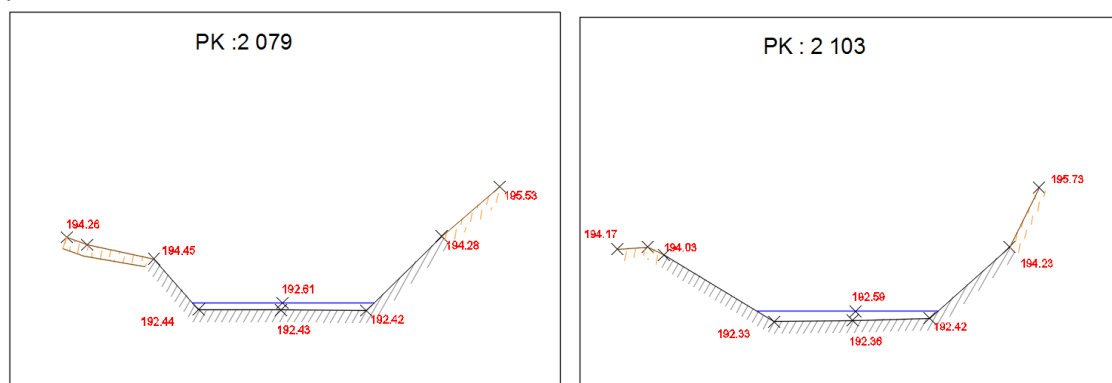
Sections du canal au niveau de la surverse en amont du tunnel du Servant
